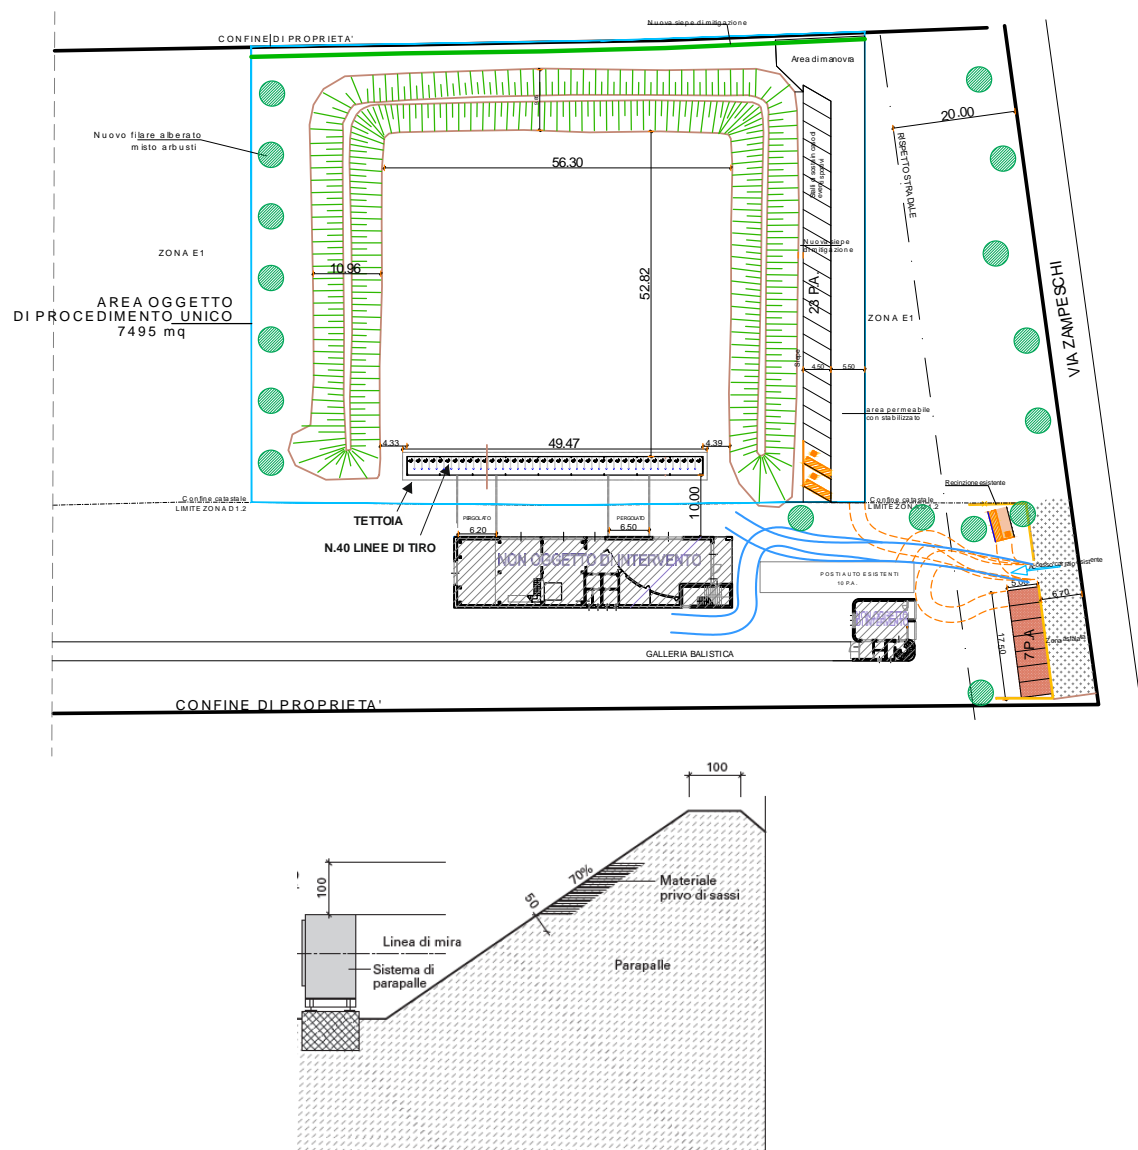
Planimetria generale + Schema tipo del rilevato in terra
